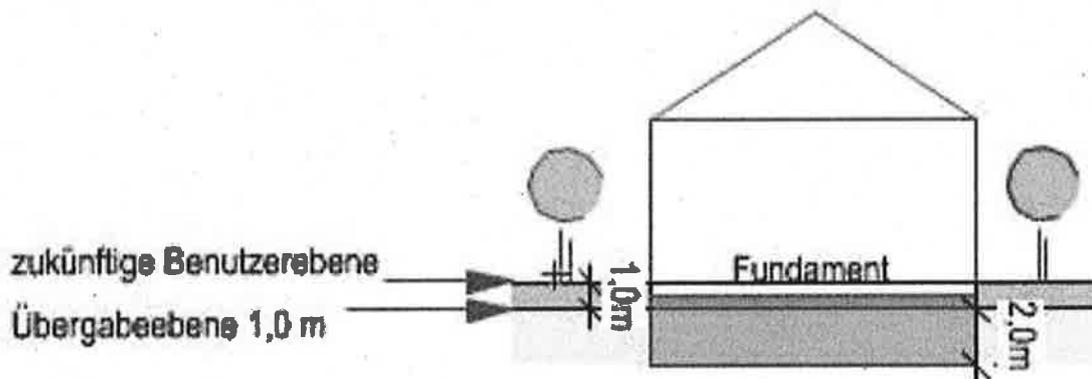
Baugrundaufbereitung gemäß Sanierungsplan für das Gelände Haus Aden 1/2
